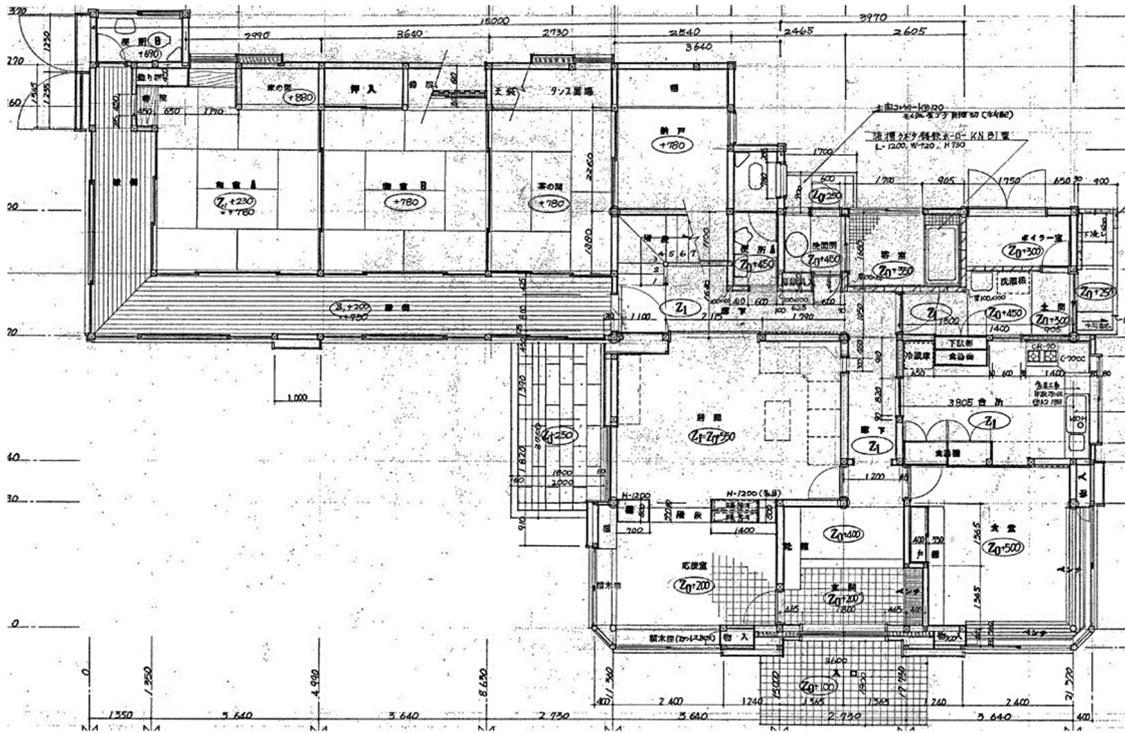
「長谷川邸 (H 邸)」 (1974) 1 階平面図
